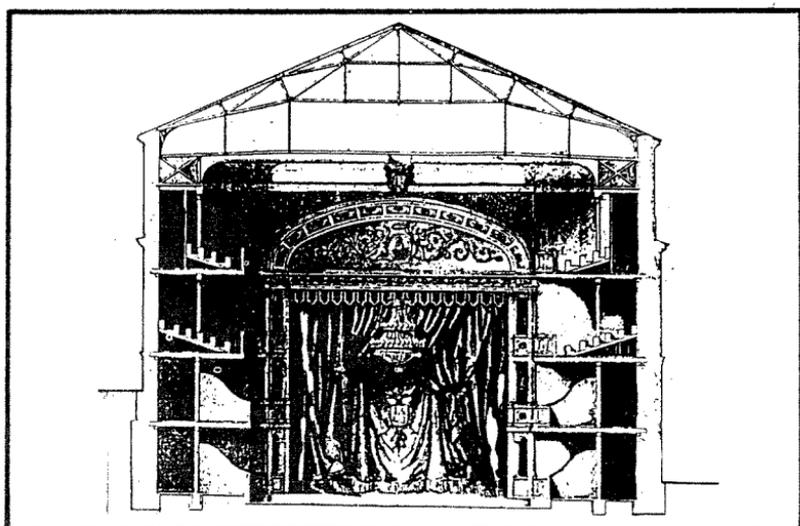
Proyecto Fenech de 1866. Alzado interior, corte transversal de la sala. (A.M.T.).
